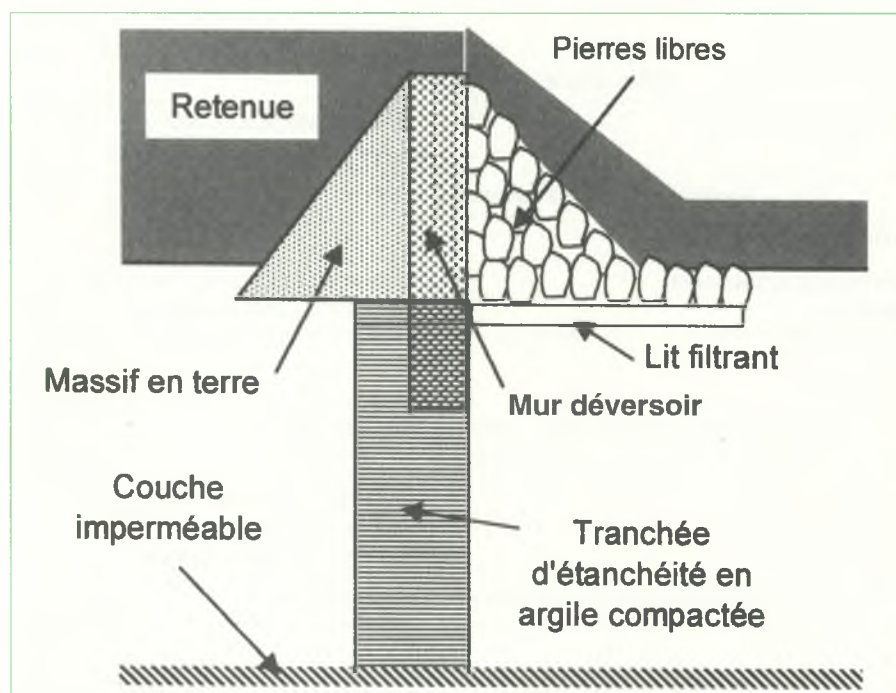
Schéma d'une digue déversante avec tranchée d'étanchéité.
